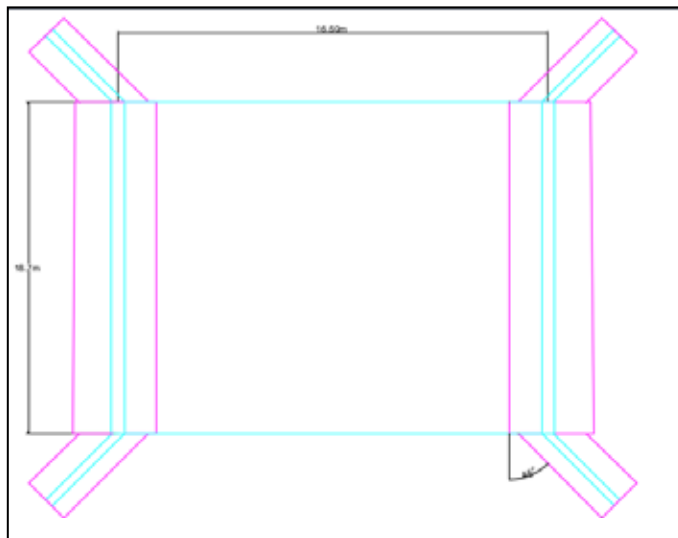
Vista de planta del puente sobre la Avenida 168 Salvador Feo La Cruz
